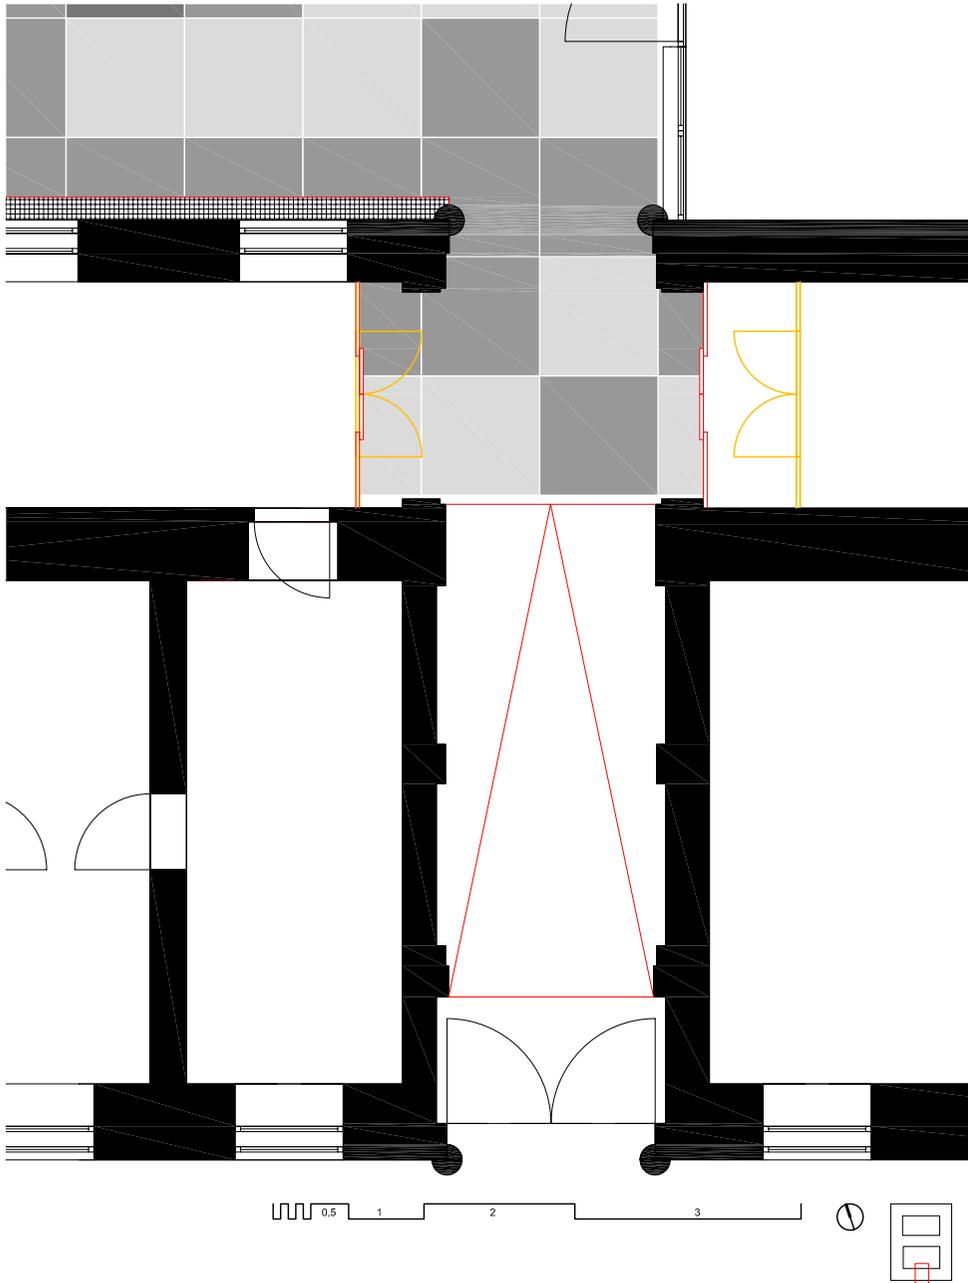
Darstellung der Rampe im Durchgang zum ersten Hof
